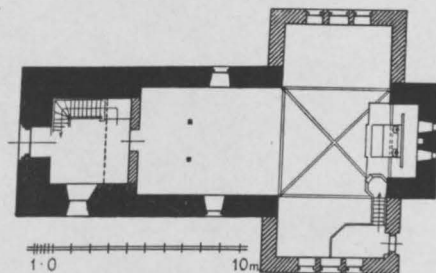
Arneshain. Grundriss der Kirche.
